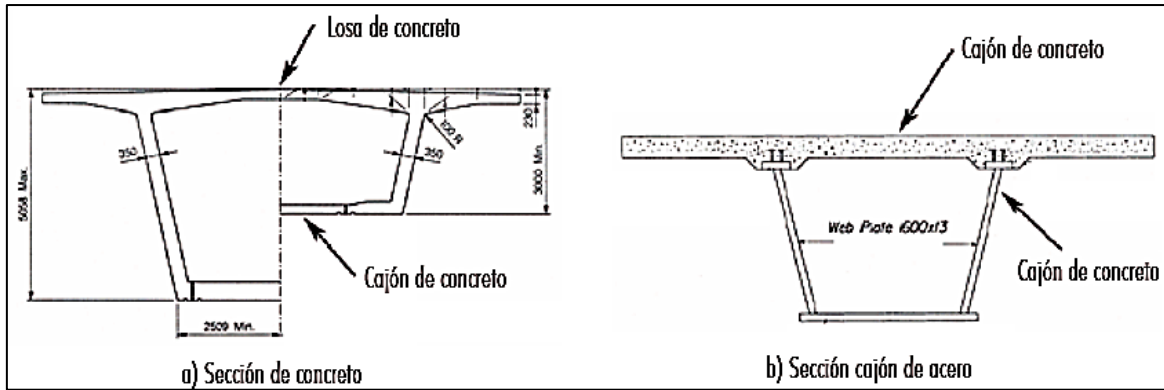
Superestructura formada por un cajón de concreto o acero y losa de concreto
